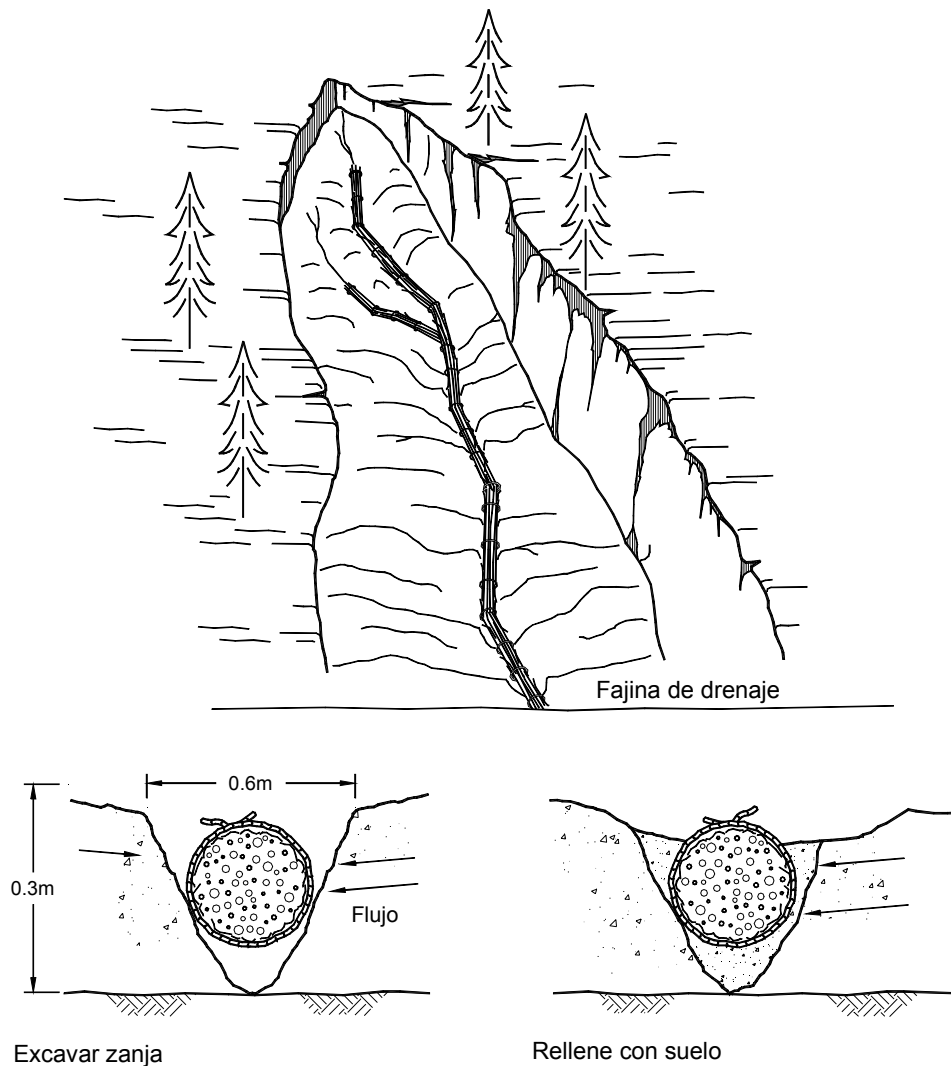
Fajinas vivas de drenaje (McCullah, 2001).
